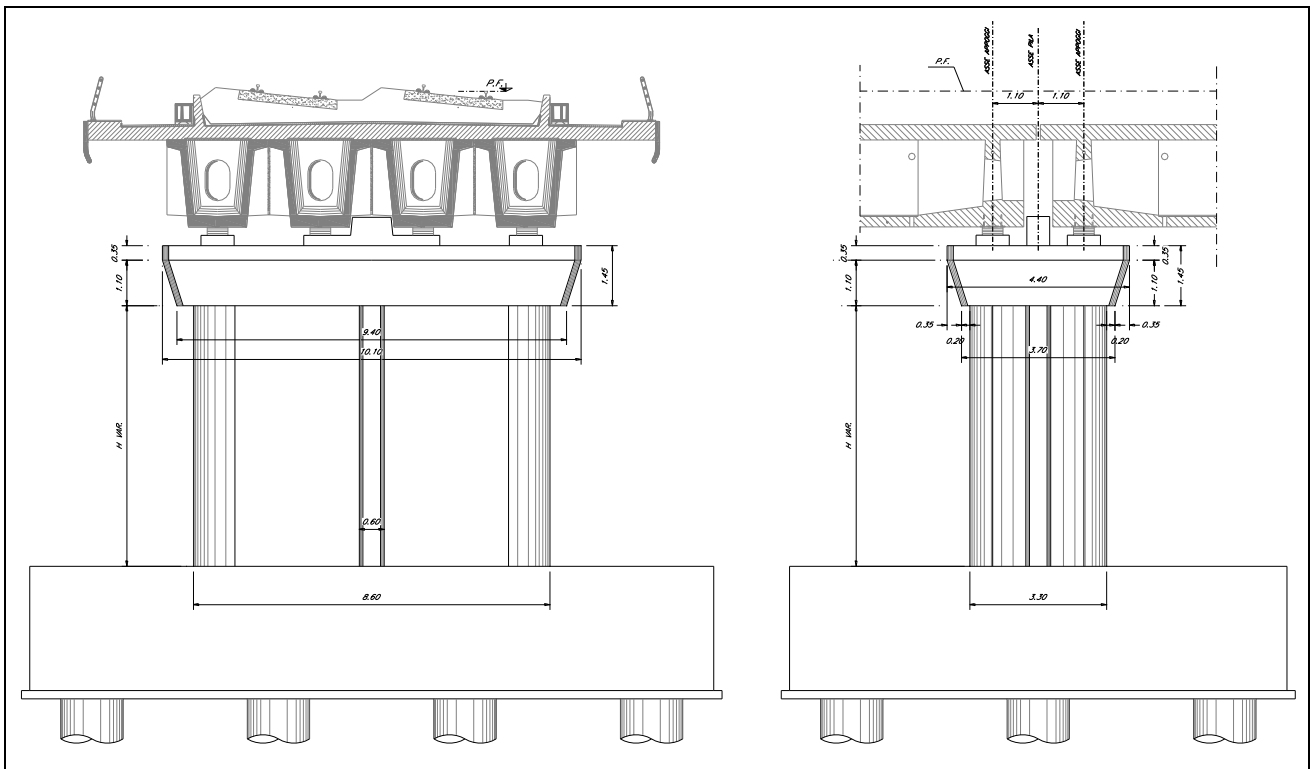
Viste pila tipologica per impalcato L=25.00m, sezione 2.60m x 8.60m
